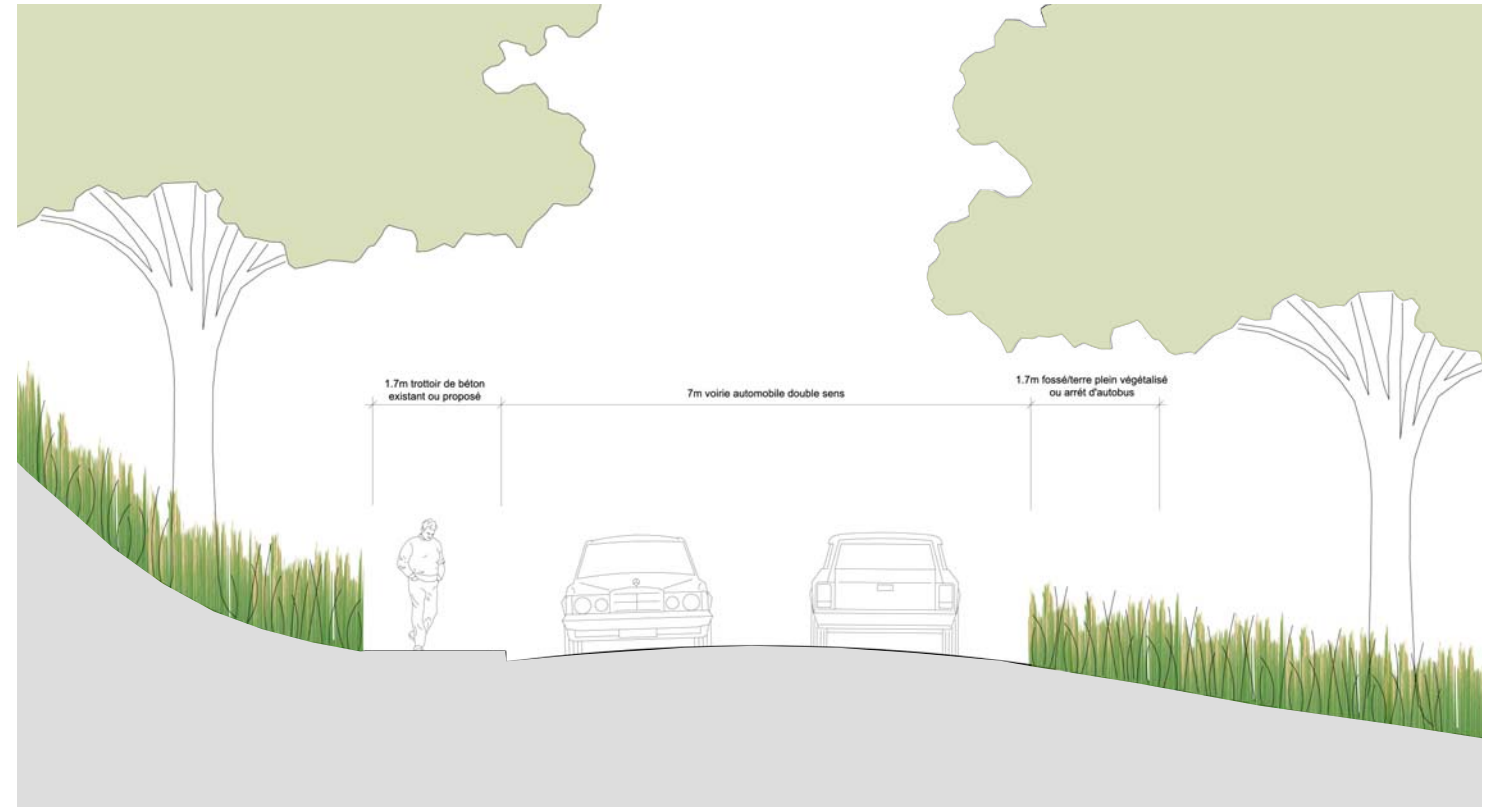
Coupe transversale 02, chemin Remembrance, échelle 1:100
